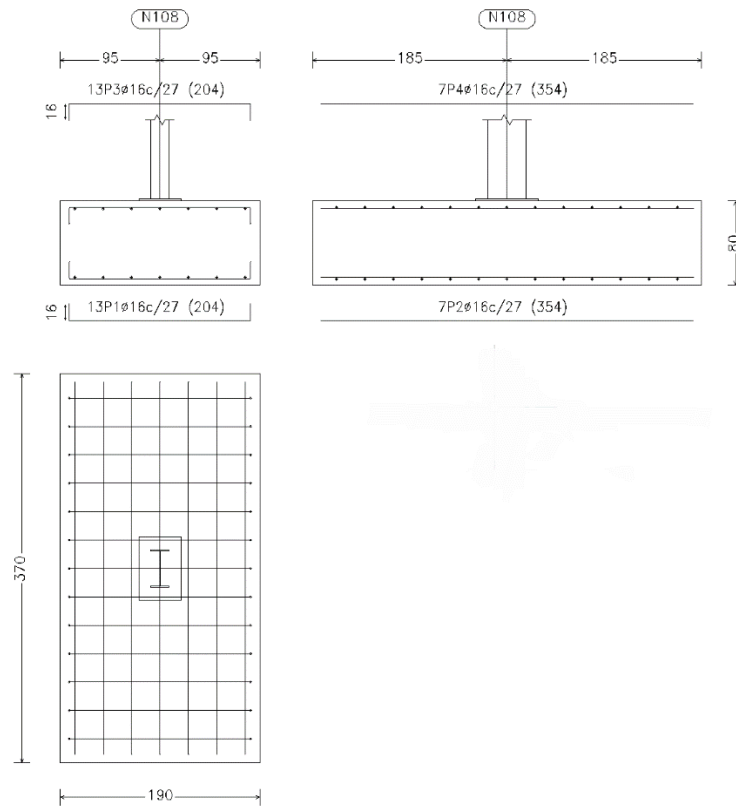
Dimensiones zapata pórtico fachada intermedia.
